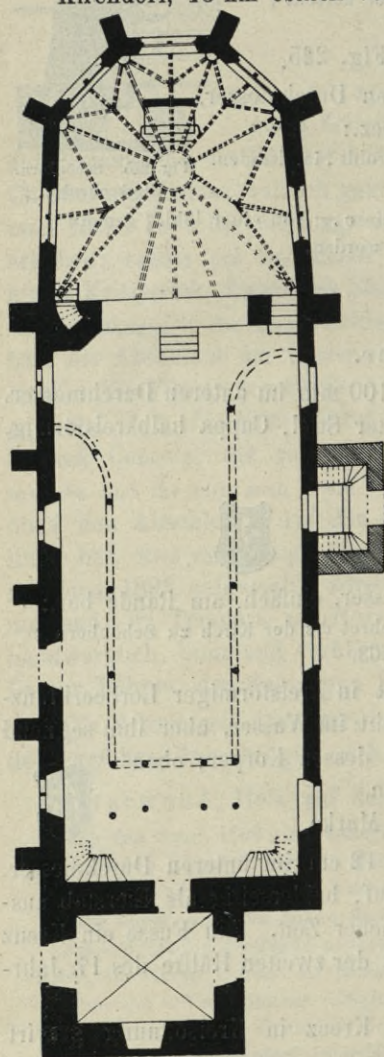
Schönfeld, Grundriss der Kirche.
